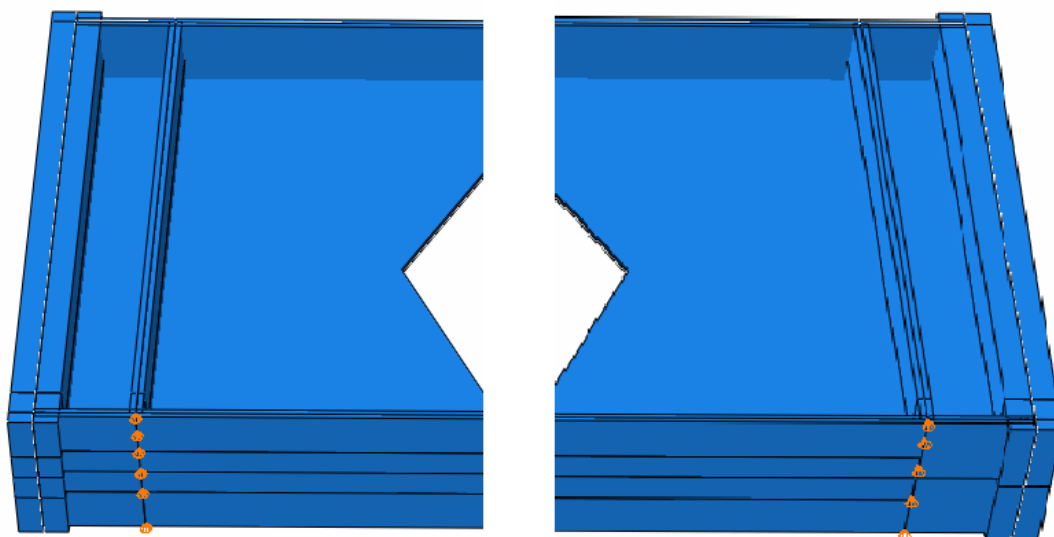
Detalhe da vinculação de apoio na viga (biapoiada).
